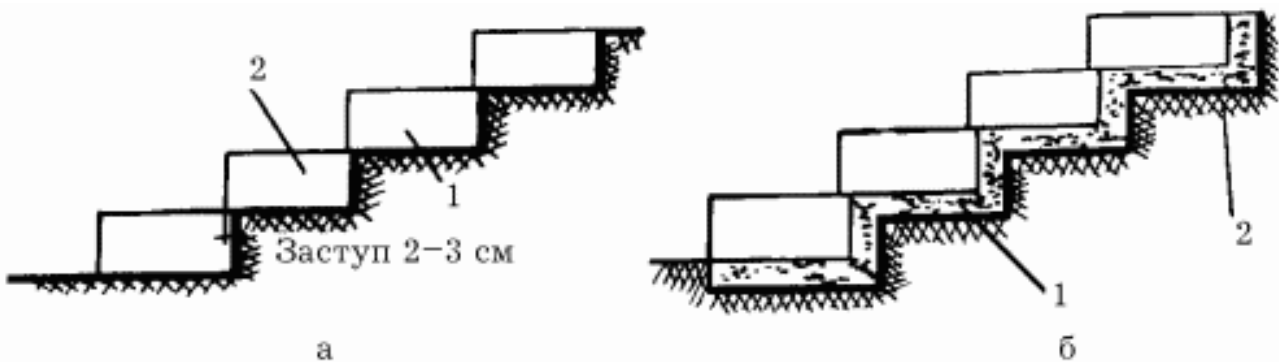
Профиль укладки лестницы из готовых бетонных блоков: а) на слежавшемся грунте: 1 – грунт; 2 – блок; б) на насыпном грунте: 1 – основание из бутового камня; 2 – утрамбованный грунт.
